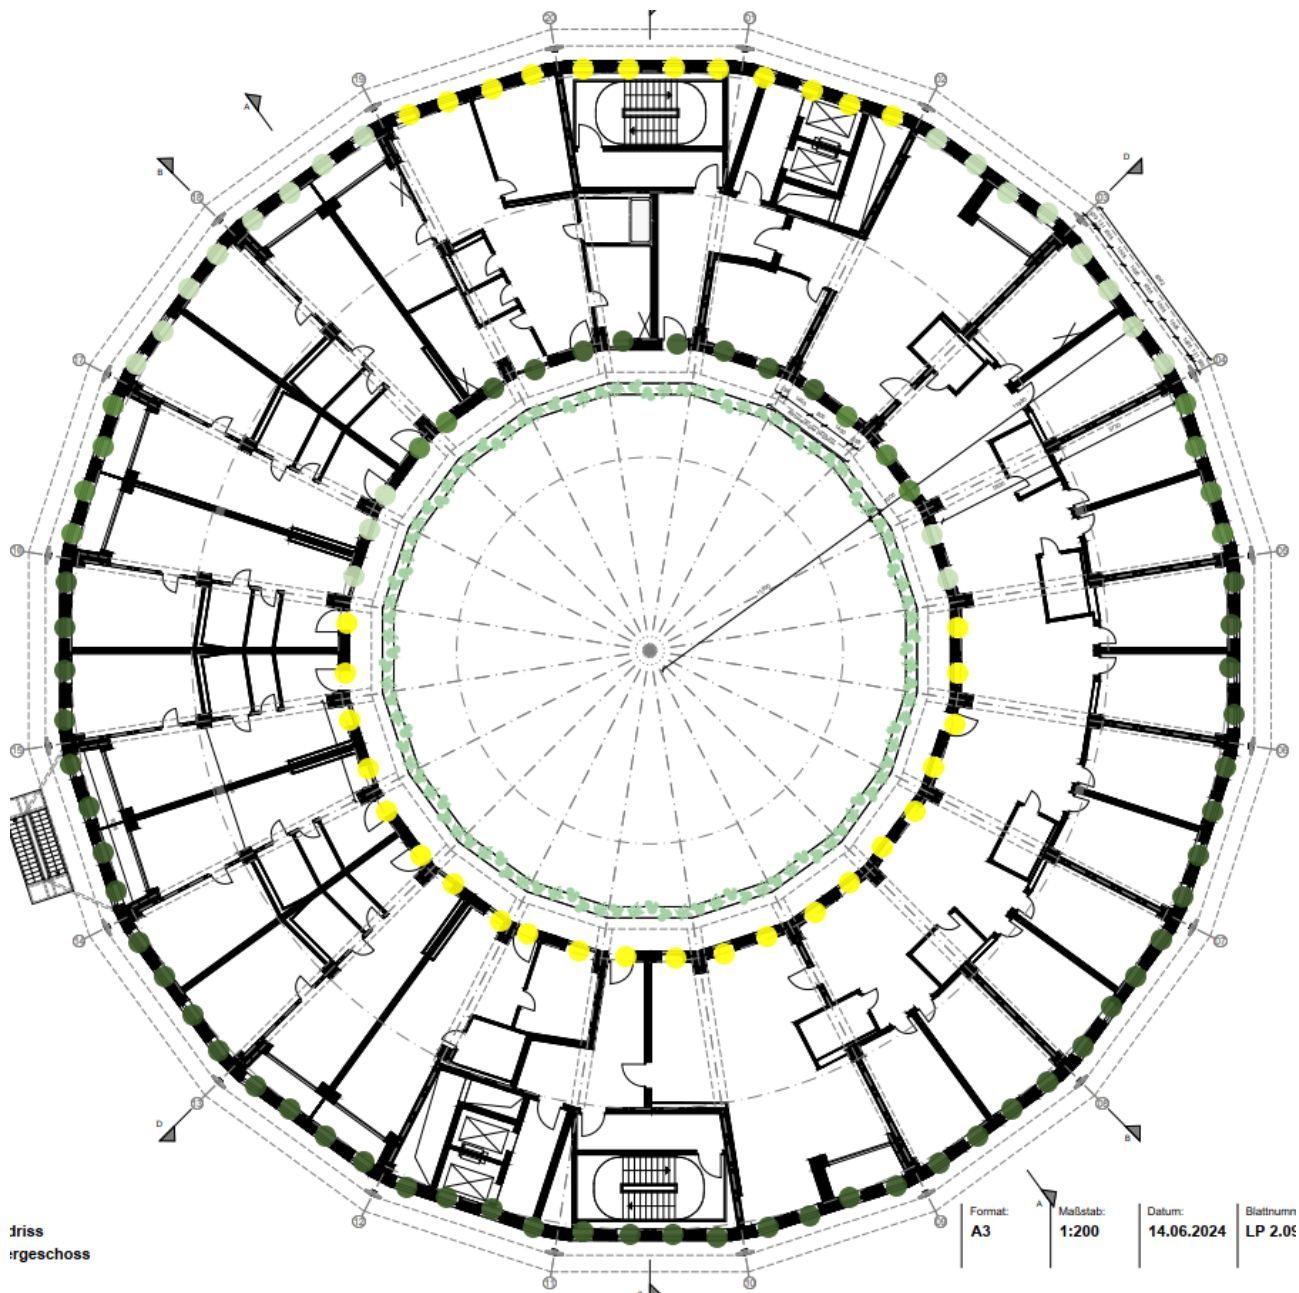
Darstellung der Ergebnisse auf den Grundrissen, 9. Obergeschoss
